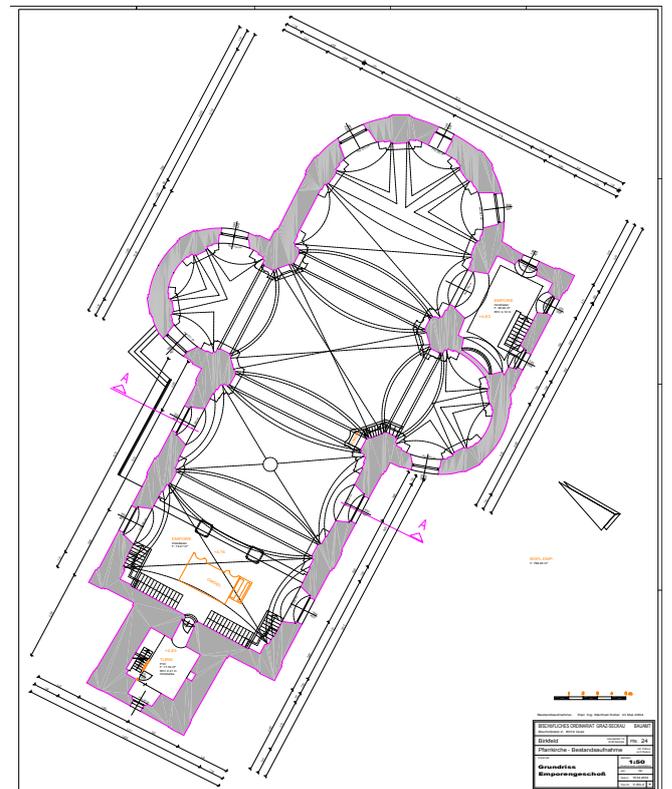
Grundrissplan der Pfarrkirche Birkfeld - Emporengeschoss
